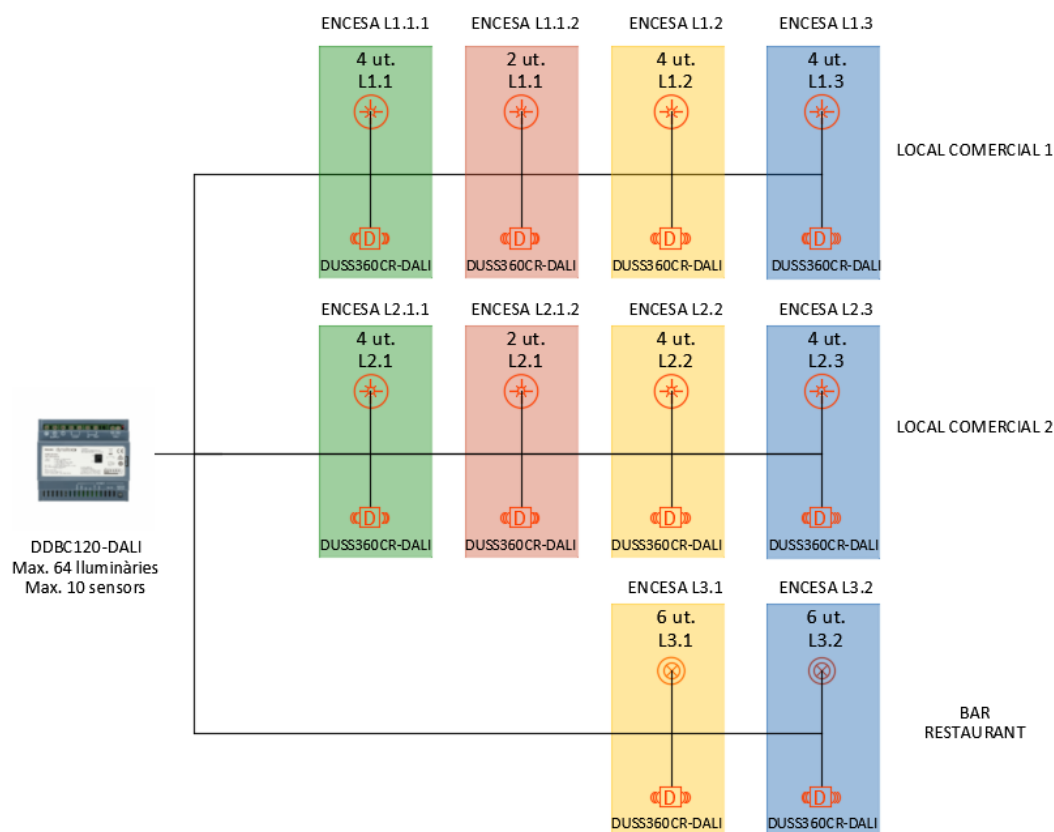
47. Esquema sistema de control de la Planta Baixa. (Font: Elaboració pròpia.)
